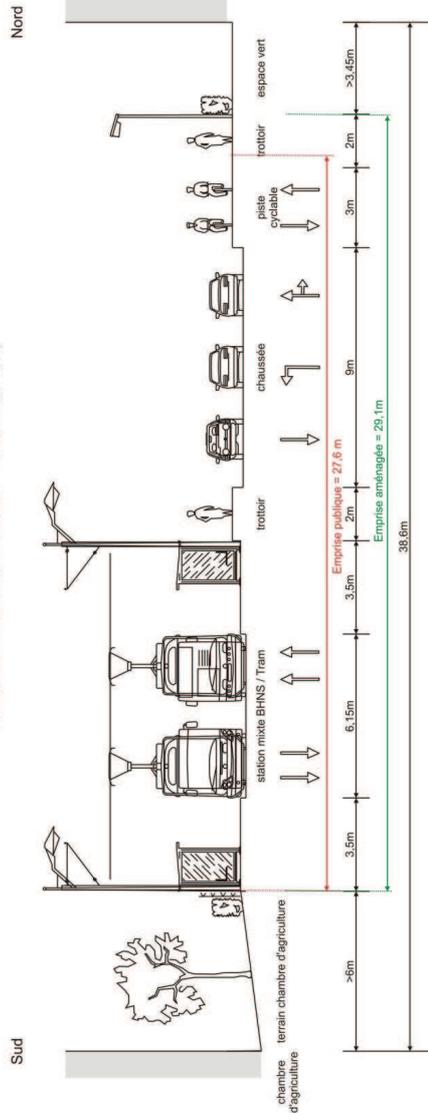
Situation projetée (coupe 12) route de Hausbergen, station "Europe"
